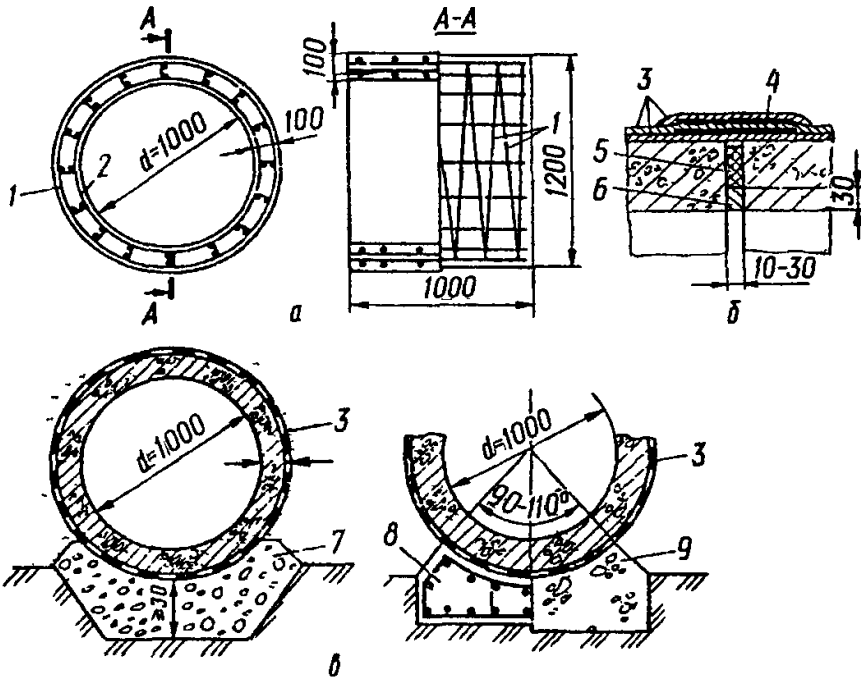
Конструкція ланок круглих залізобетонних труб.
